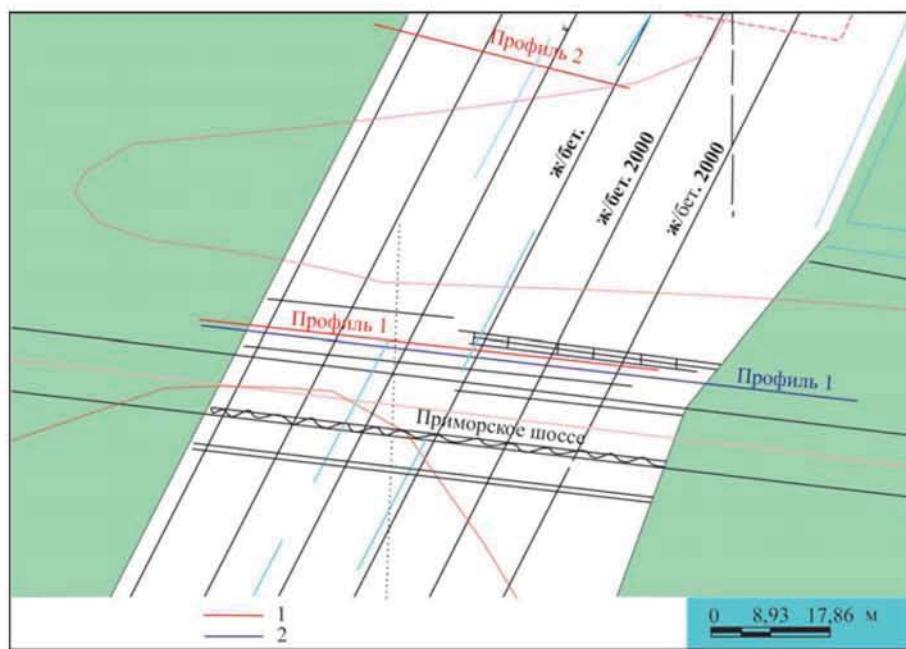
План обследованного участка трубопроводов. Условные обозначения: 1 — профили электротомографических измерений; 2 — профиль георадиолокационной съемки; ж/бет. — железобетонные трубопроводы
